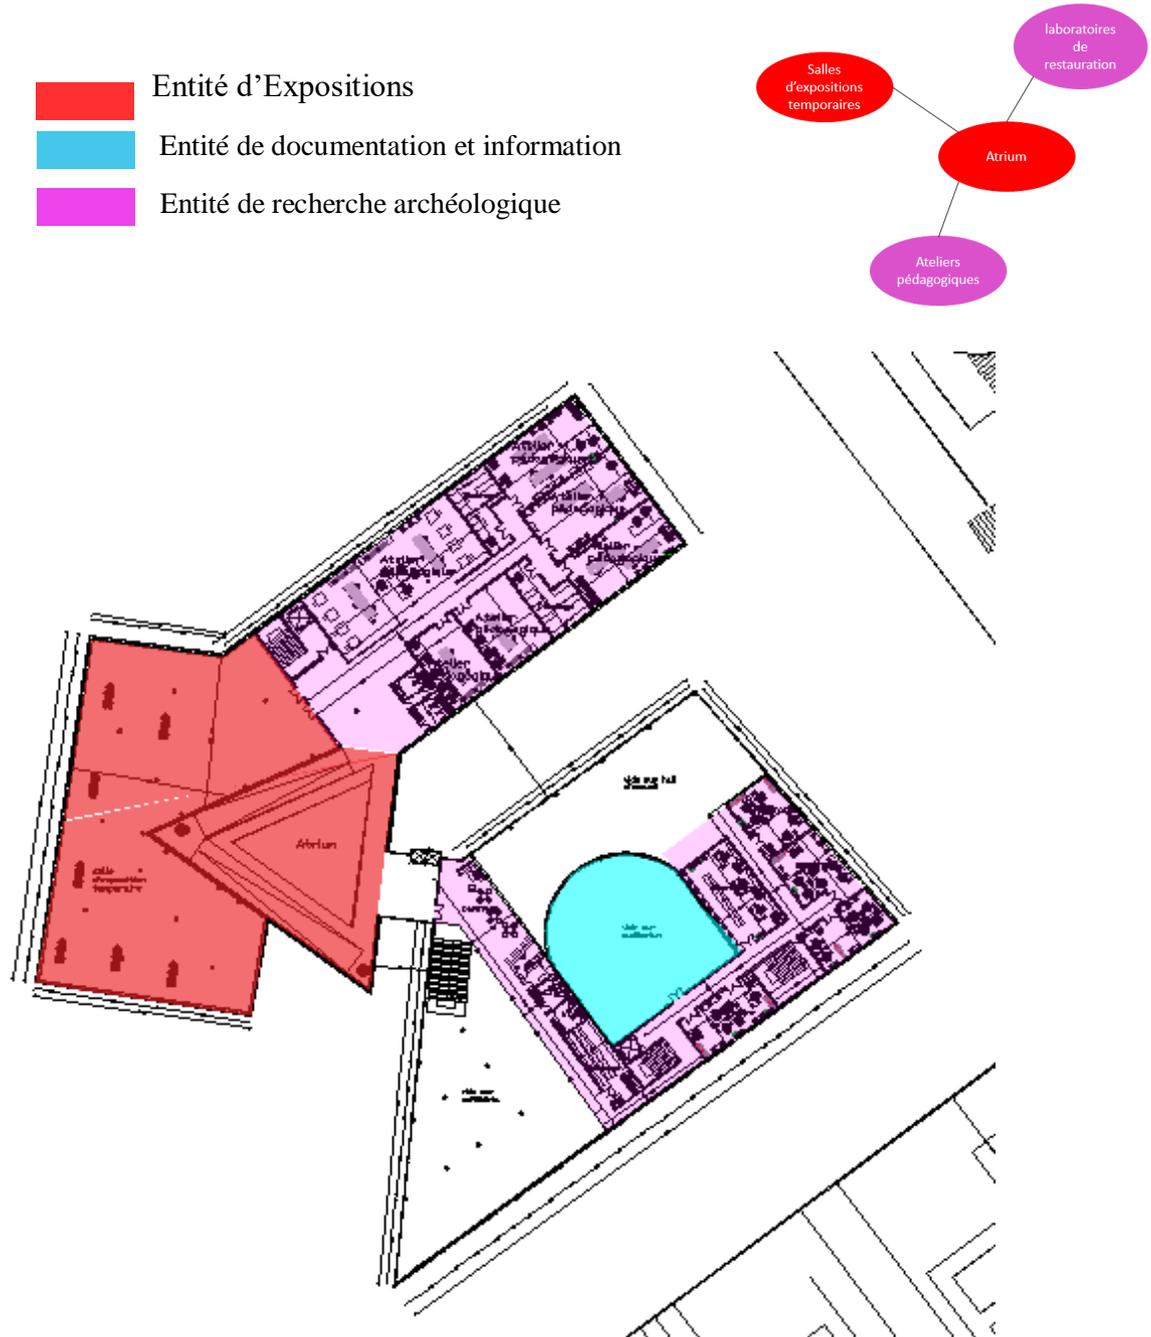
plan de 1<sup>er</sup> étage. Source : l'auteur
